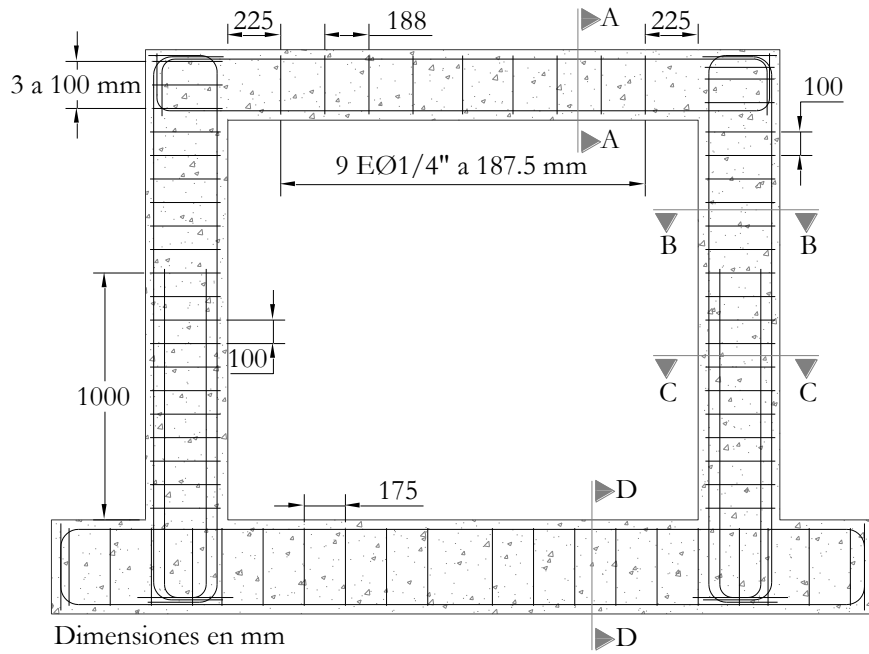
Detallado del refuerzo del pórtico *P1
